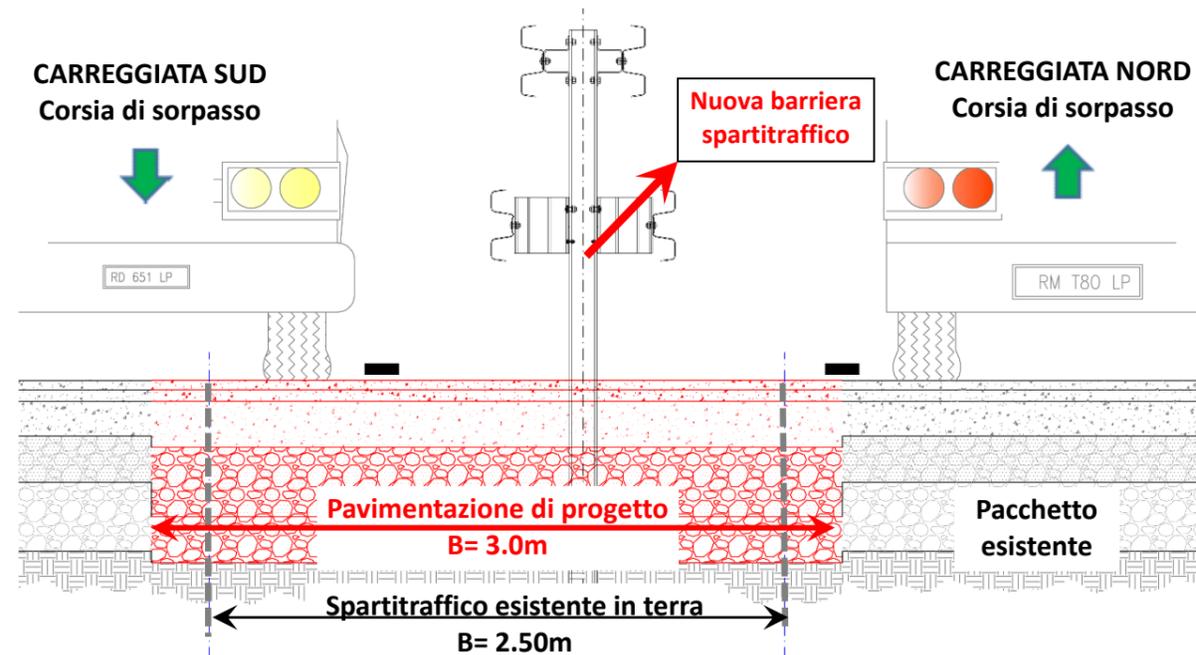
Riquilifica dello spartitraffico - dettaglio intervento sulle pavimentazioni
